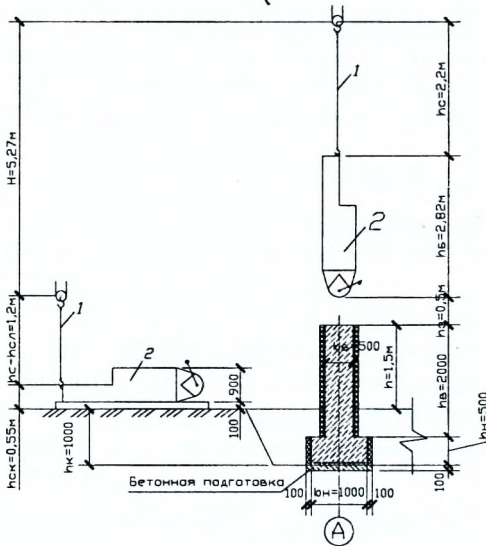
Схема к определению высоты подачи бетонной смеси в опалубку ленточного фундамента краном в бадьях с размещением крана на бровке
